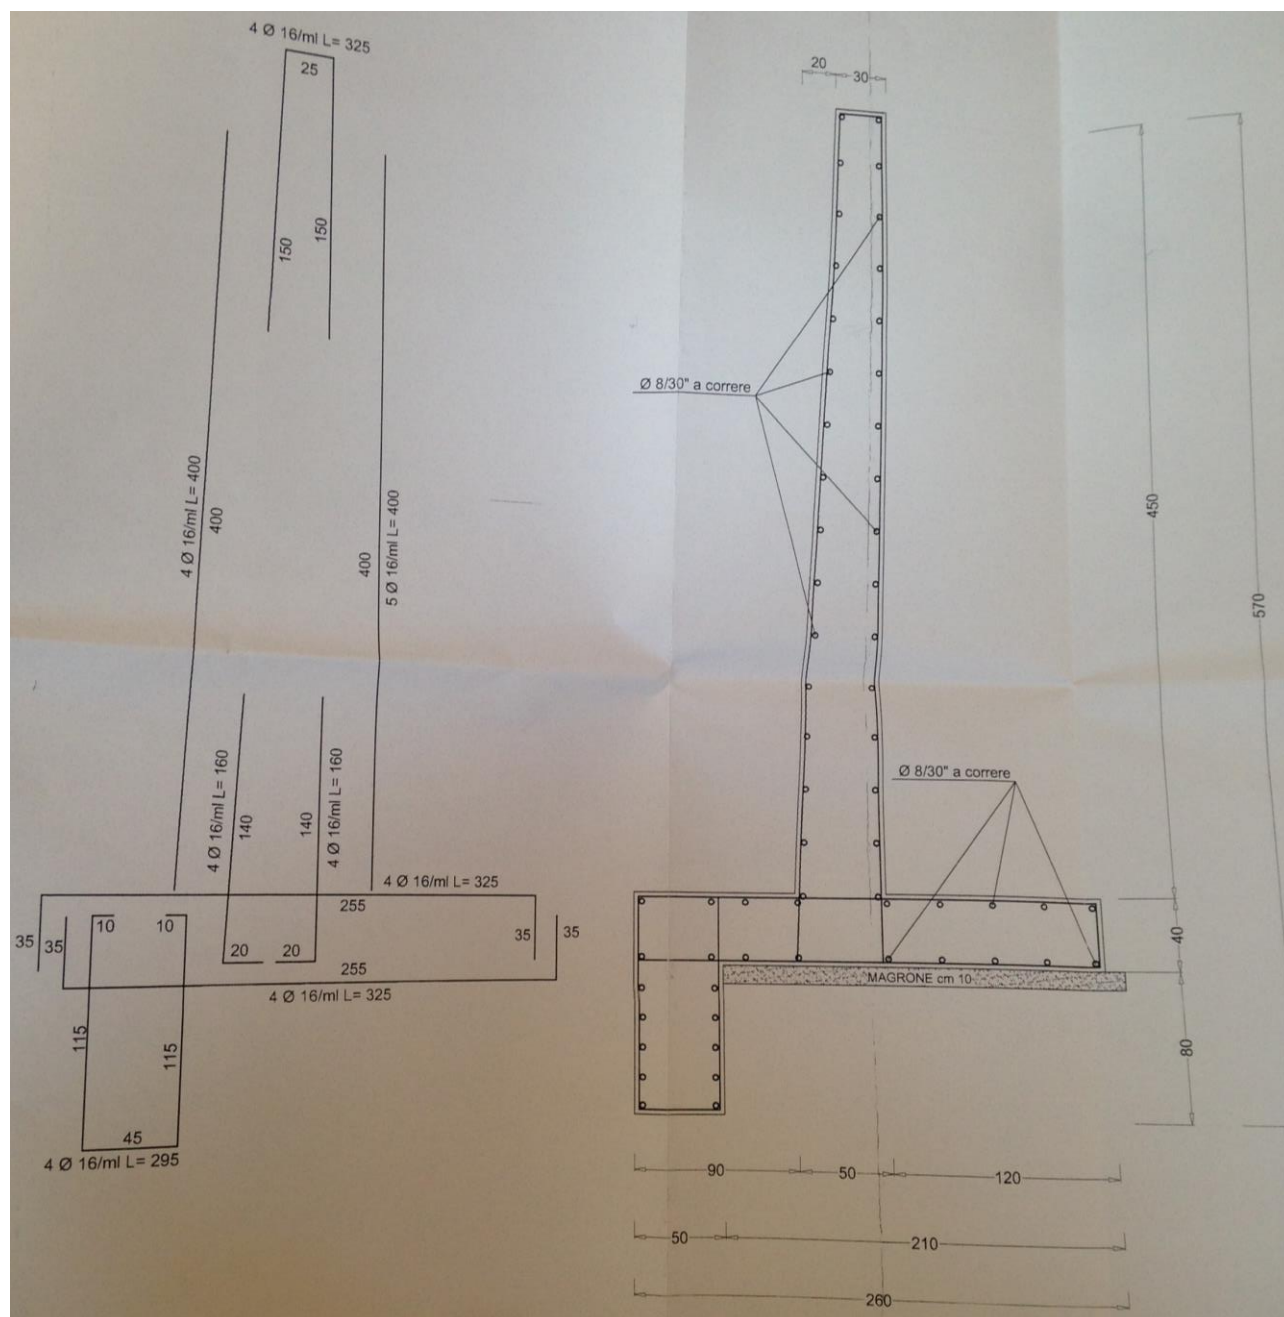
Sezione muro in c.a. – Estratto Pratica Sismica N. 373/2009
